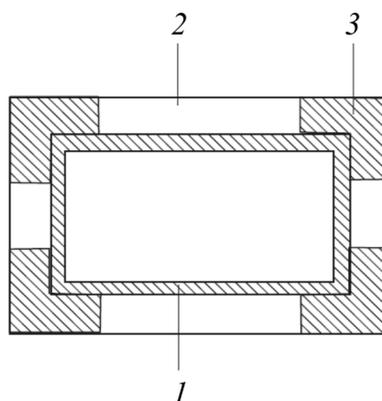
Схема утепления фундамента: 1 – контур здания; 2 – утепление по периметру здания; 3 – дополнительное утепление в угловых зонах фундамента
